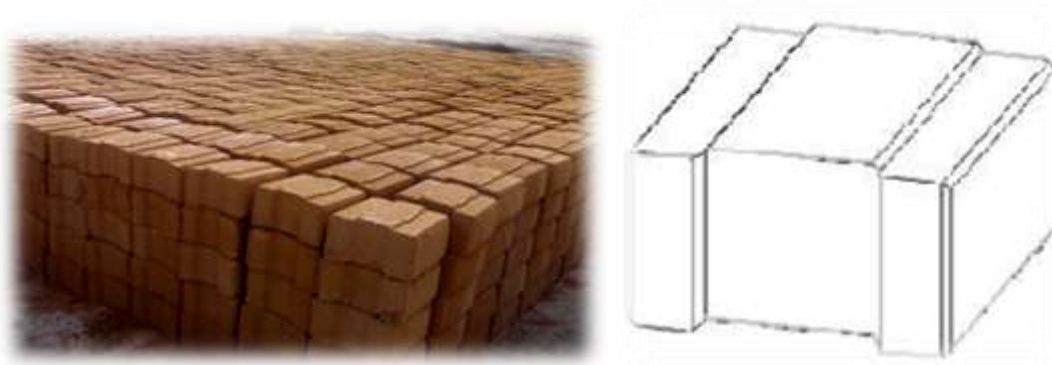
Sistema constructivo para muros: Hydraform (Simion, 2009)
